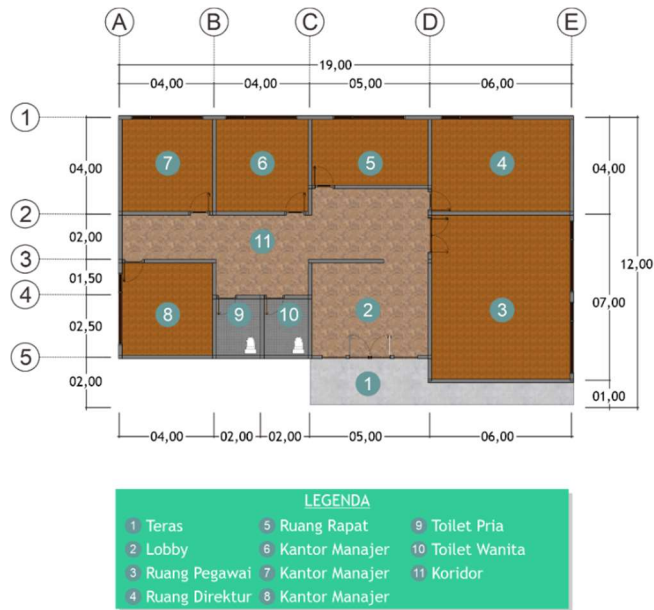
8 Denah Lantai 1 Gedung Pameran
